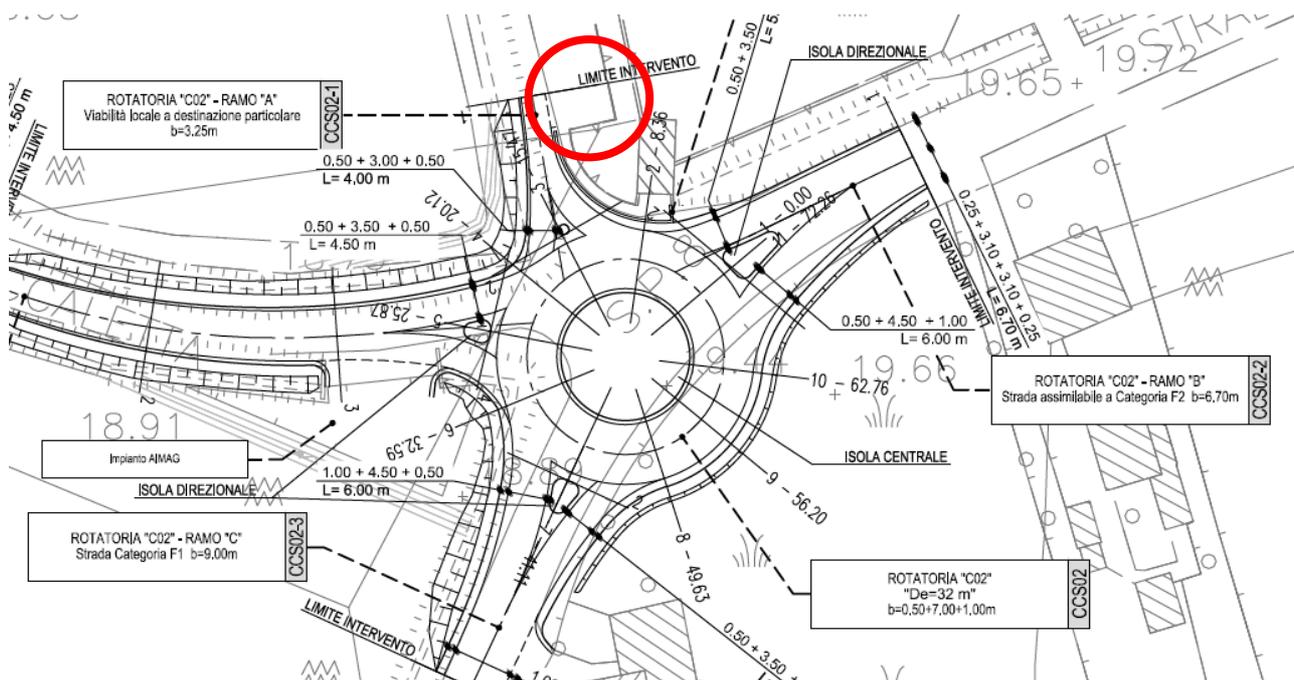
STRALCIO PLANIMETRICO C02 (IN ROSSO L'ACCESSO ALLA CAPPELLA
